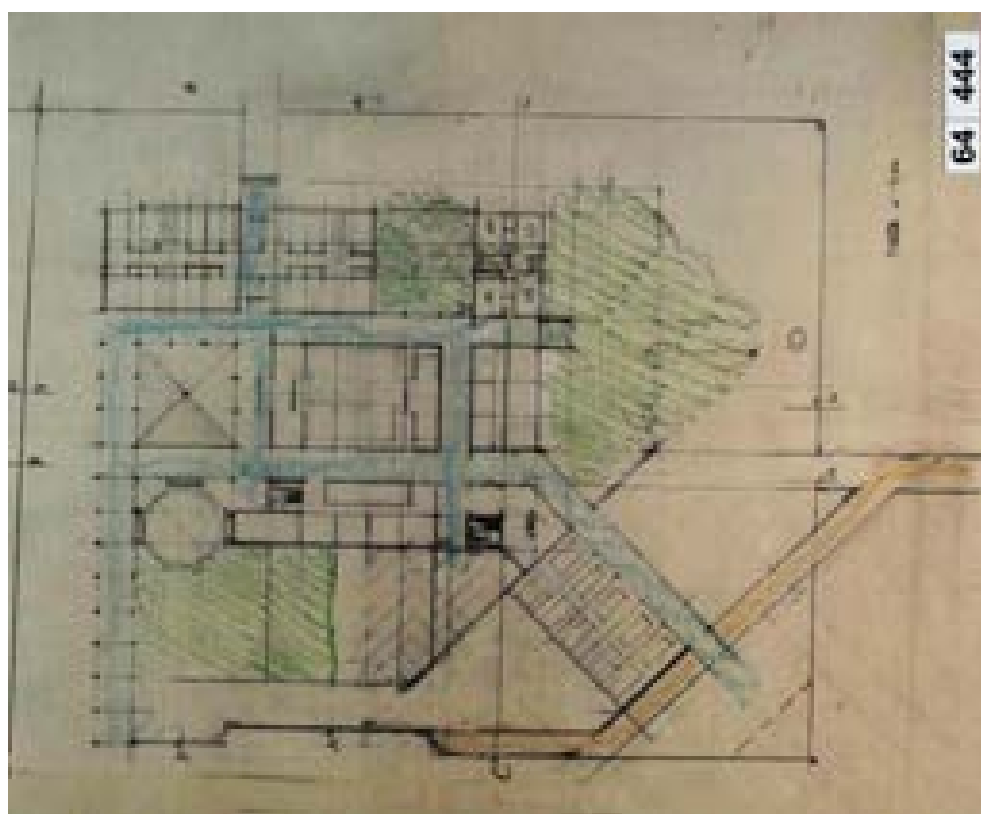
Planimetria maglia strutturale +1,00, stato futuro - 1989 (AABS-64_444)
